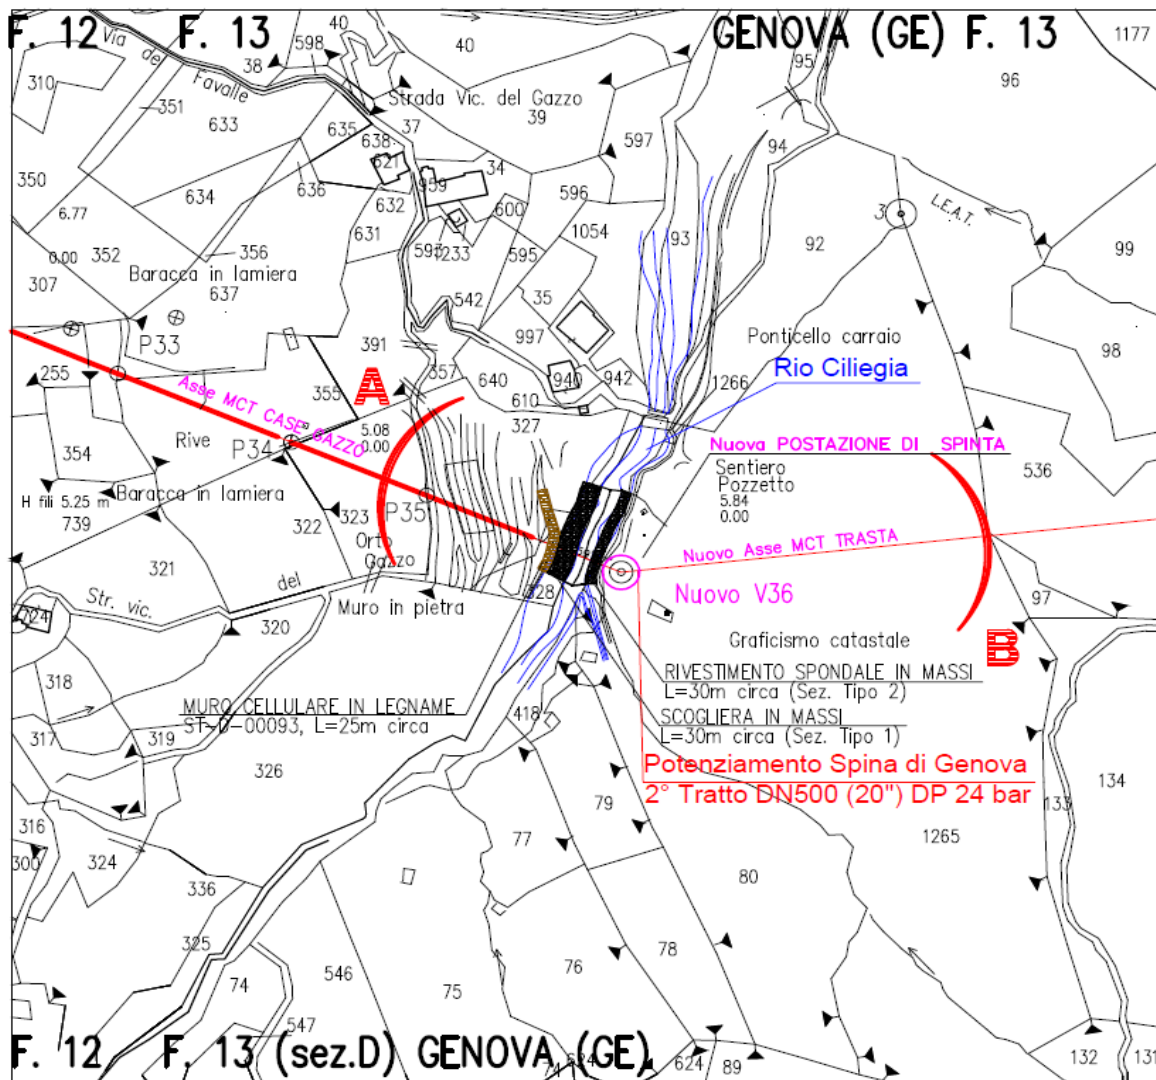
Planimetria con indicazione dei microtunnel e del pozzo di partenza degli stessi
